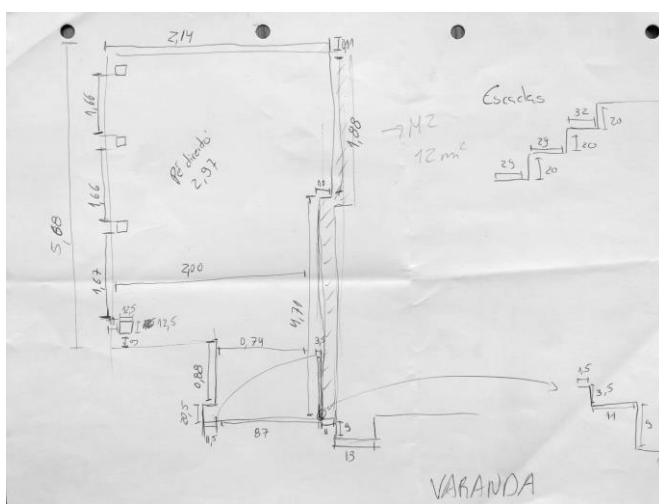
Levantamento de medidas da varanda exterior. Fonte: Ana Ferreira.
